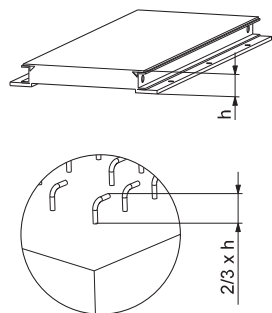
Усиливающие стальные стержни, устанавливаемые в фундамент
